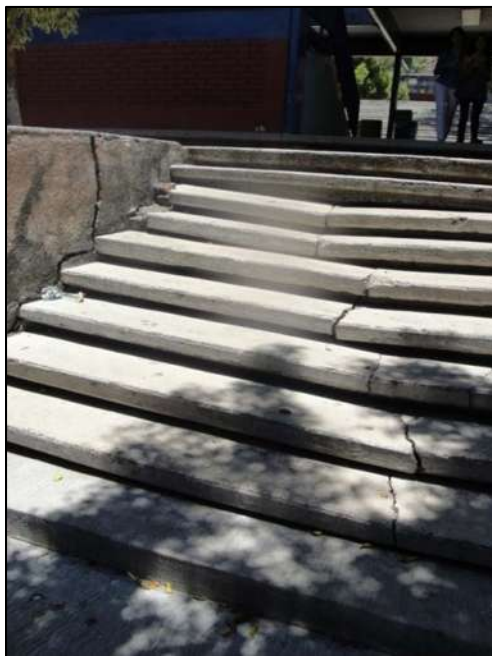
Fracturas y grietas en las escaleras de acceso al primer nivel de terreno.
